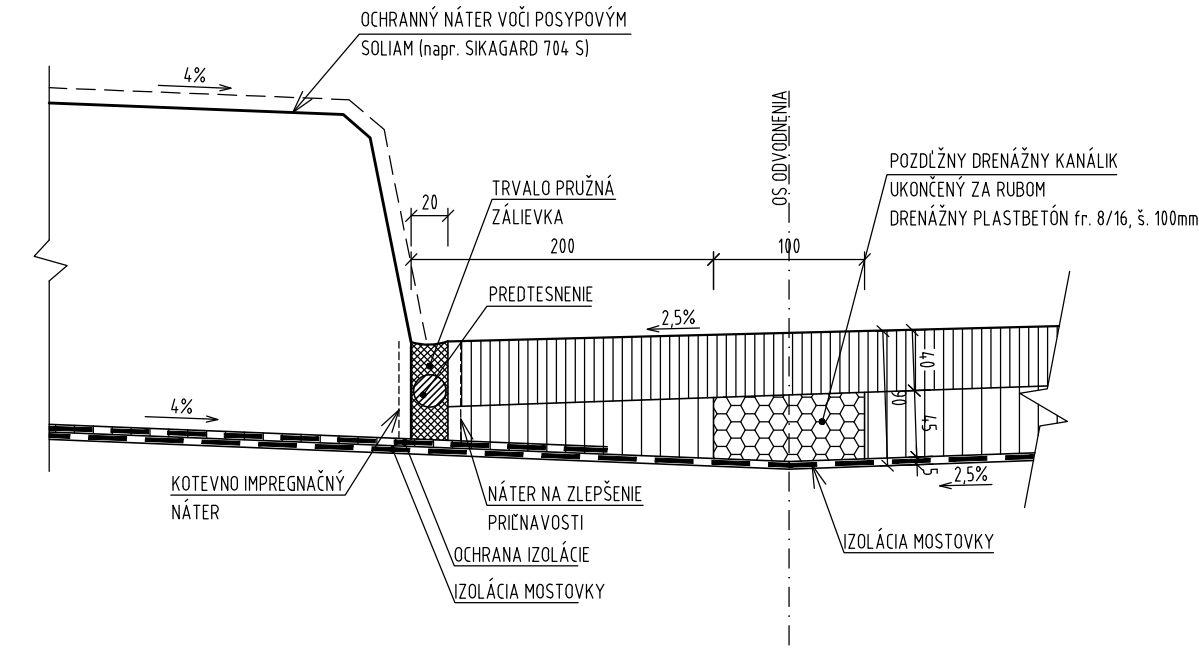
DETAIL PRACOVNEJ ŠKÁRY M 1:5
